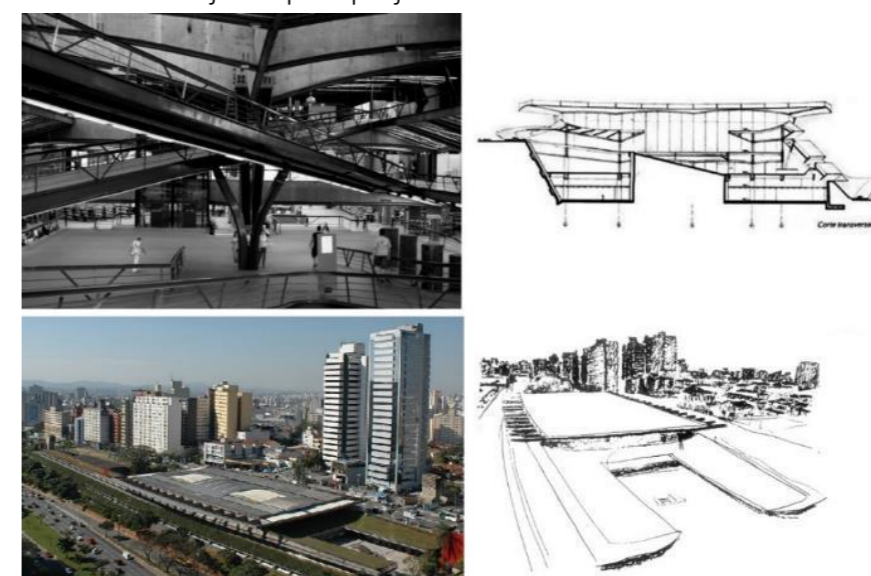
Imagens interna e externa, corte e croqui do Centro Cultural São Paulo. Fonte: (Archdaily, 2017)
